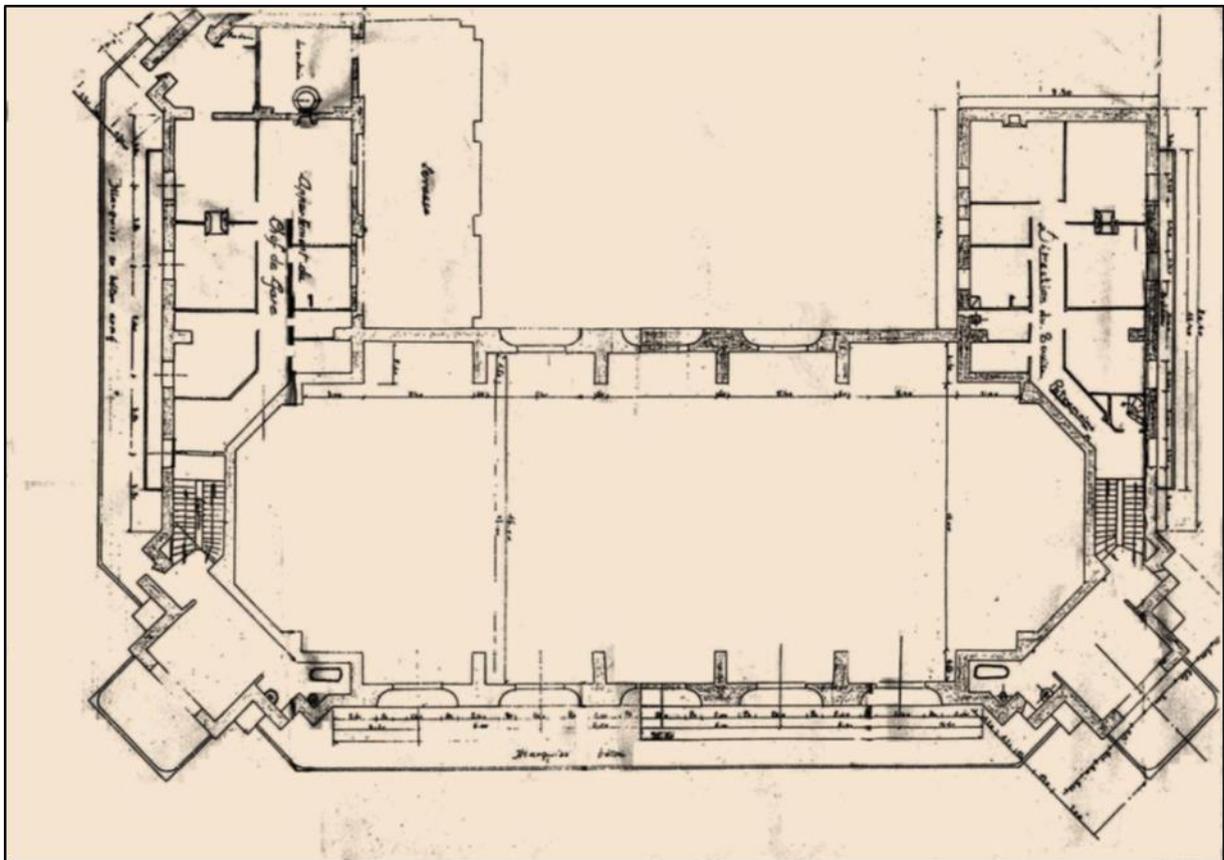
Plan rez-de-chaussée du bâtiment voyageurs de la gare ferroviaire d'Annaba
